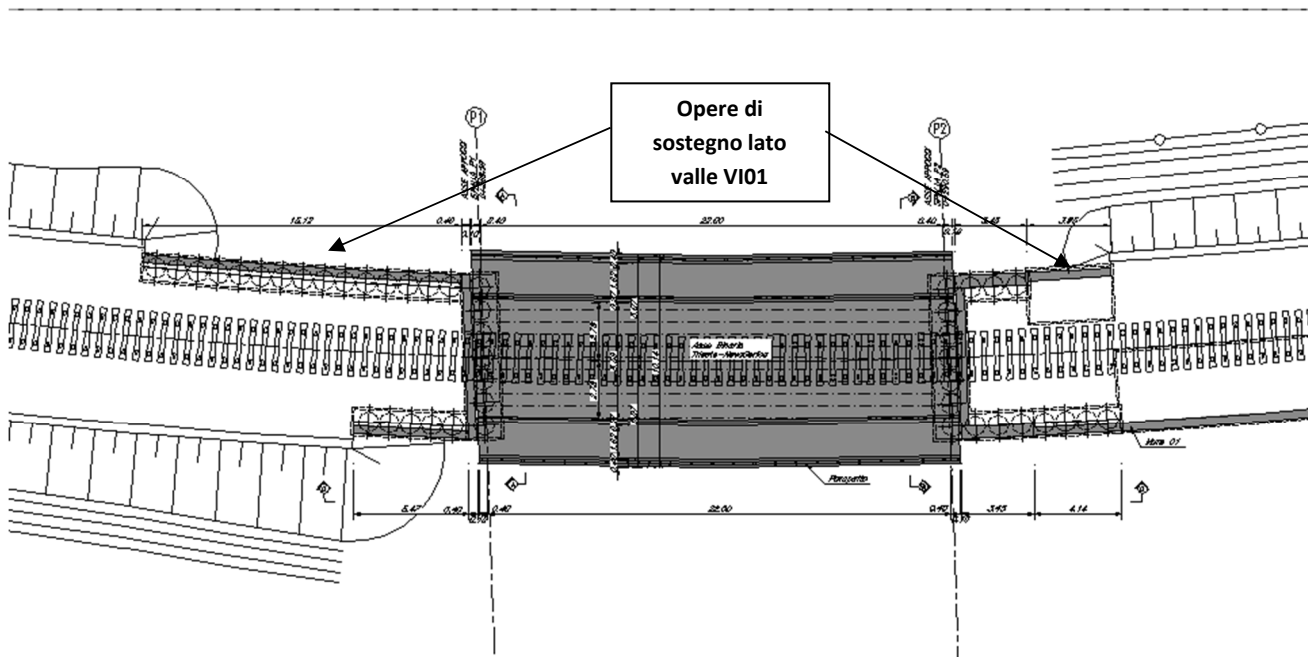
Planimetria con ubicazione dell'opera di sostegno lato valle.
